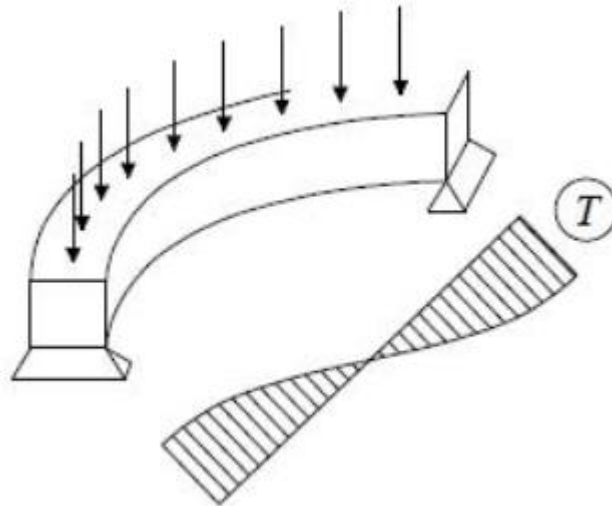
Vigas curvas no plano horizontal sujeitas a momentos de torção elevados nessas extremidades. Fonte: Autor
